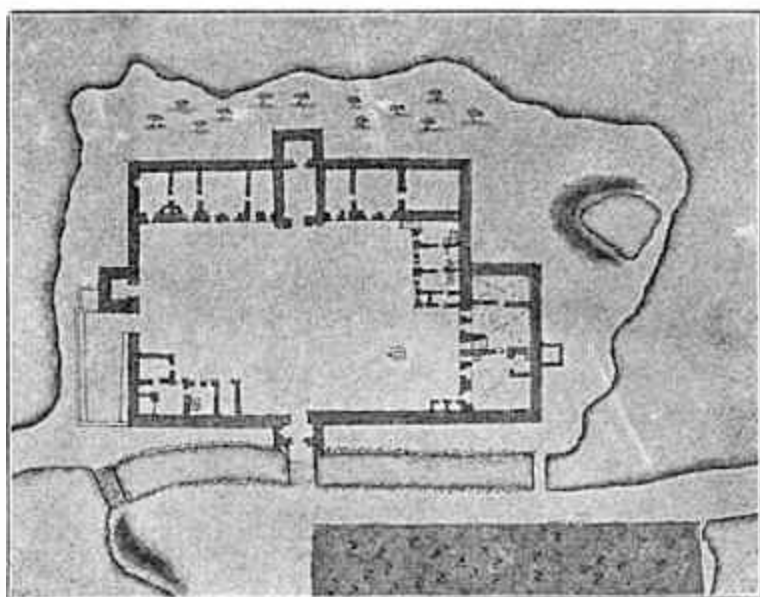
Grundriss der Burg Waldau (v. Collas).
